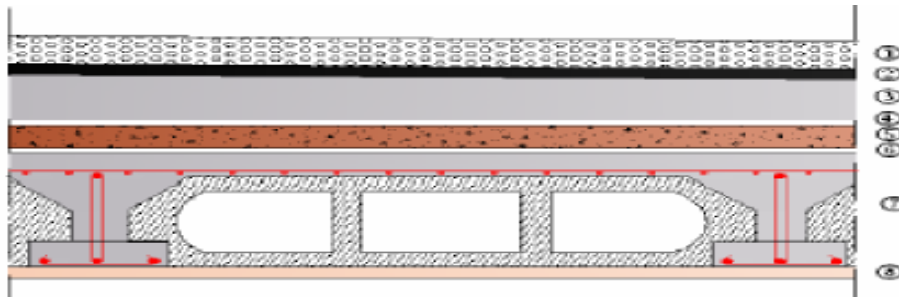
Plancher en corps creux de terrasse (inaccessible).
